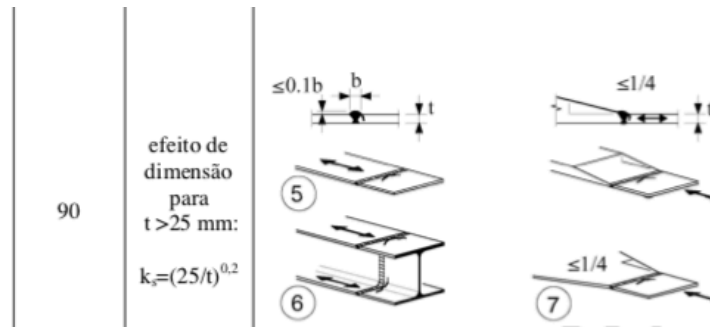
Pormenor DC 90 utilizado nas ligações soldadas horizontais (Eurocódigo 3 2010).
